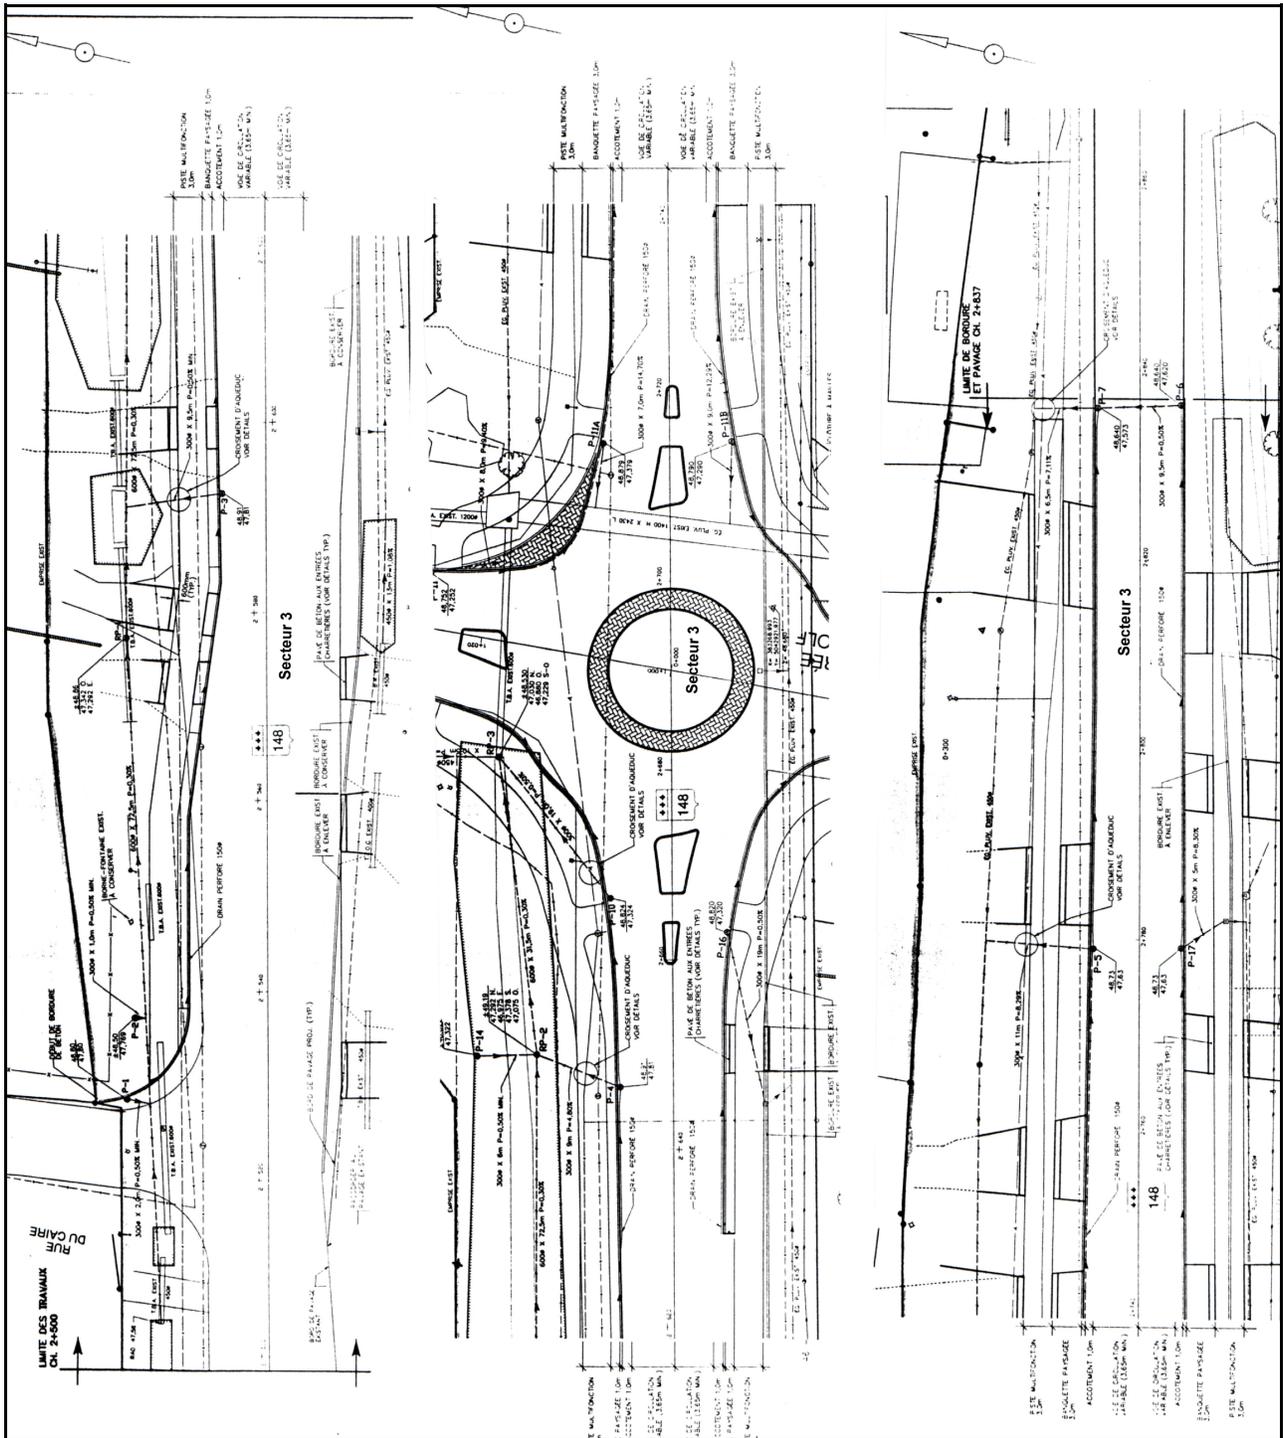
Localisation des secteurs d'inventaire sur le plan de construction du projet 20-5671-0030, route 148 et boulevard des Laurentides (2/2)
